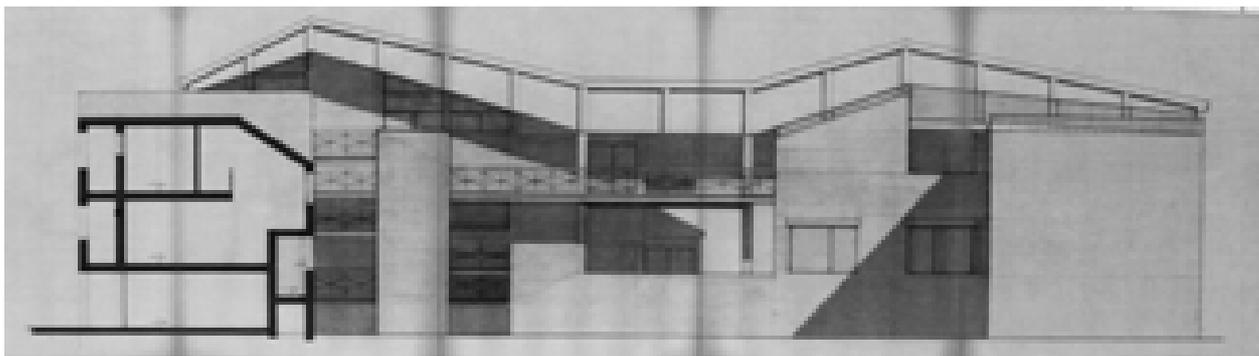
Prospetto, Sud –08/12/1981 (AABS-1996.644)
